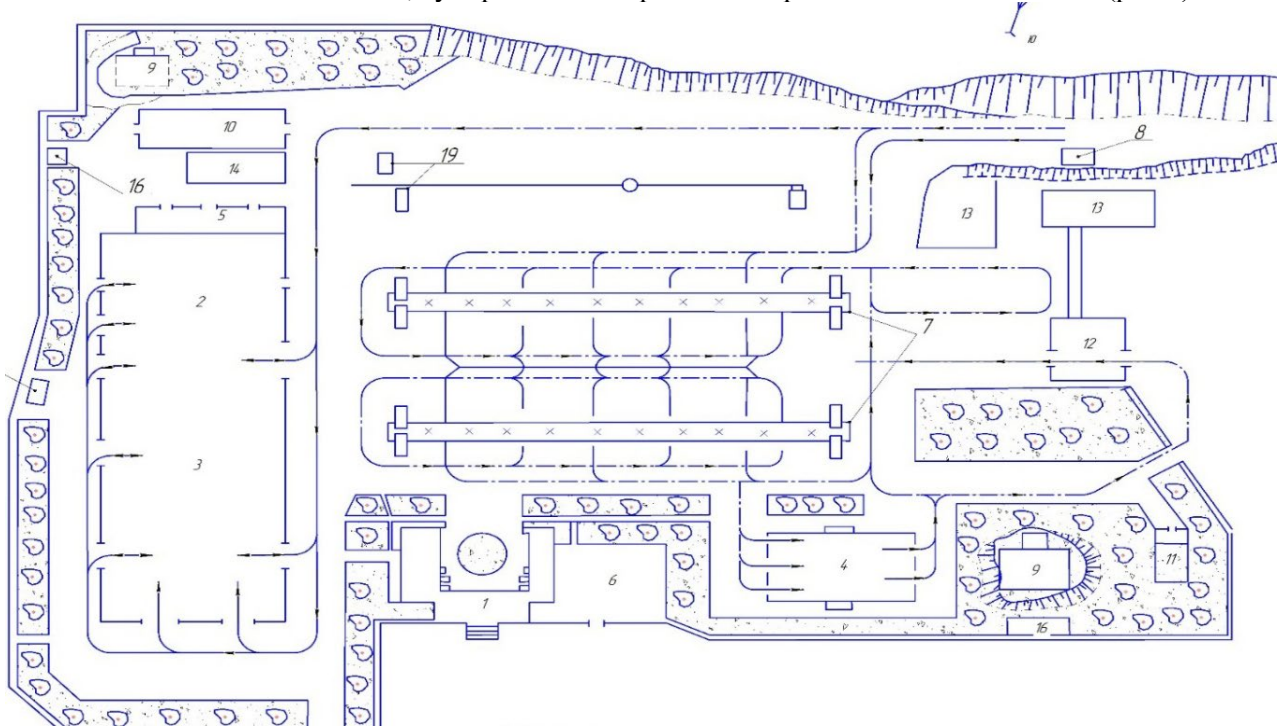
Схема гірничо-транспортного цеху. 1 – адміністративно-побутовий корпус., 2 – головний виробничий корпус, 3 – виробничий корпус 2, 4 – зона діагностики та ТО, 5 – відділ головного механіка, 6 – стоянка особистого транспорту, 7 - зона зберігання машин, 8 – контрольно-технічний пропускний пункт, 9 – притулок, 10 – склад запасних частин та матеріалів, 11 – склад вторинної сировини, 12 – мийка машин, 13 – брудовідстійник, 14 – навіс, 15 – зона зберігання відпрацьованих мастил, 16 – резервуар води, 17 – очисні споруди, 18 – пост зберігання азоту, 19 – зварювальний пост.
